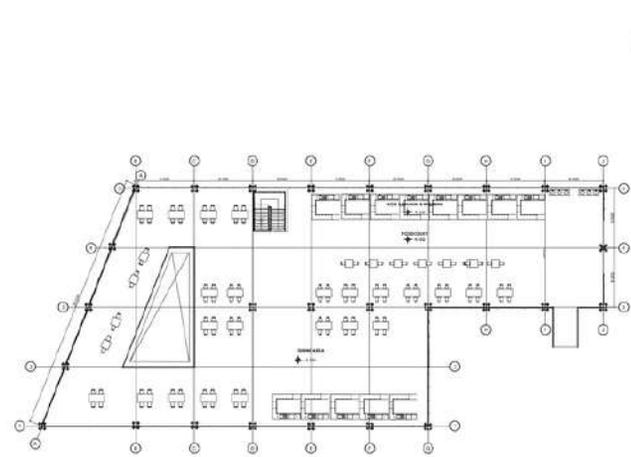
Skematik Denah Bangunan Lt 2
